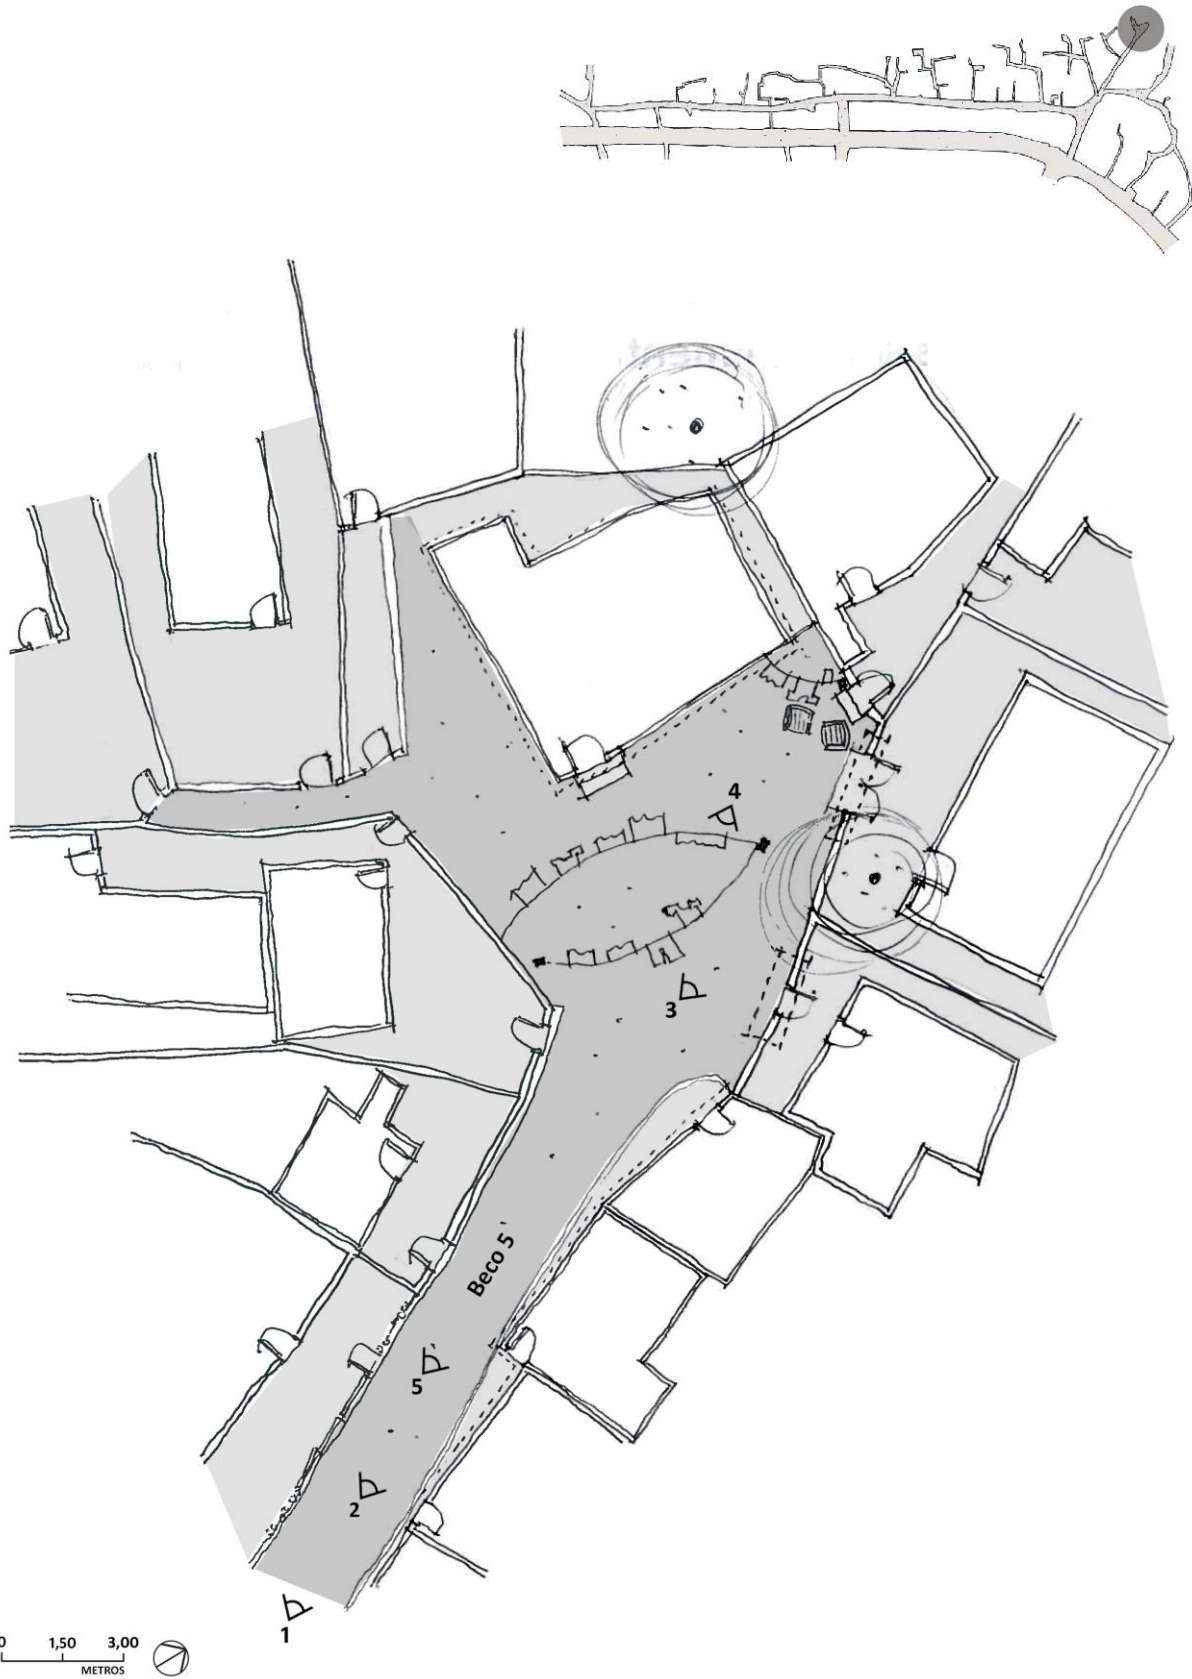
Localização. Figura 2.15 Representação em planta. Fonte: Autora.
